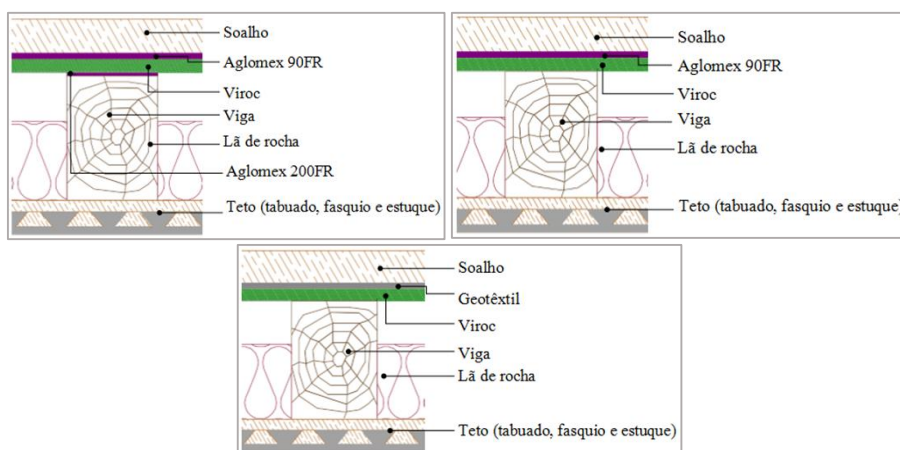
Esquemas das três soluções de reabilitação de pavimentos com teto (solução 4, 5 e 6)
